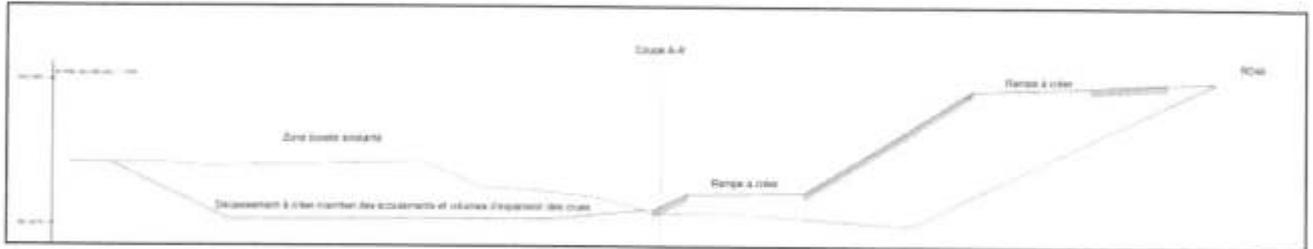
Zoom sur la rampe d'accès au pont de Zone RD 46
